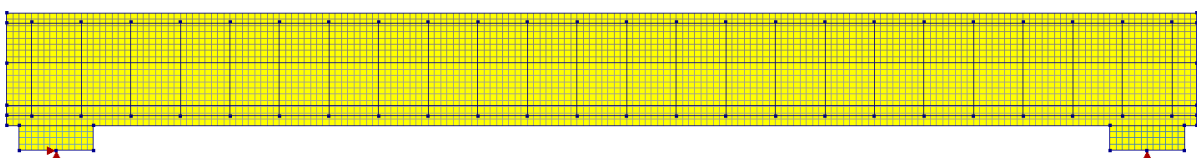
Vista del armado en una de las vigas estudiadas (T1S).
